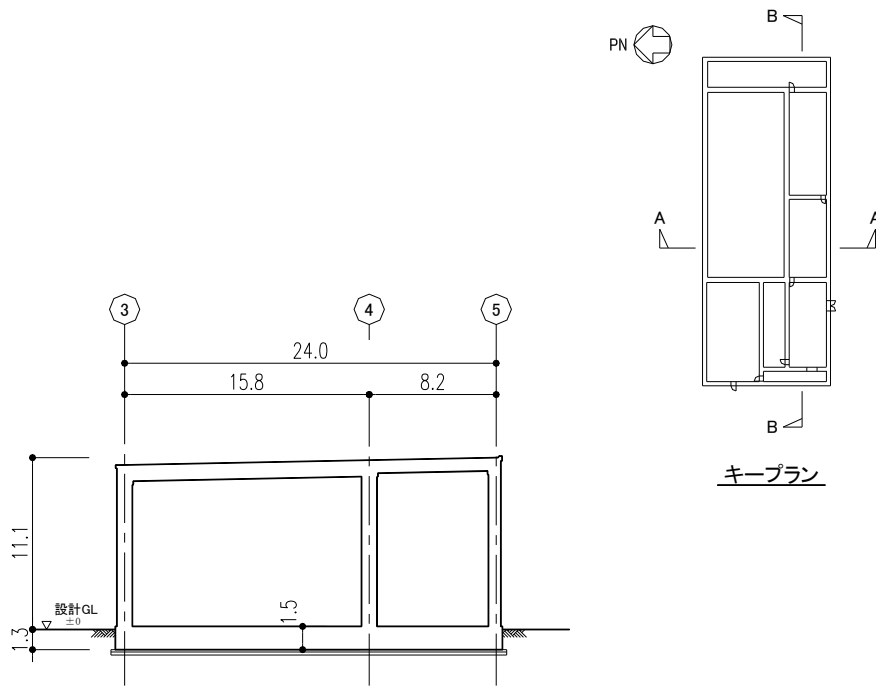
スラッジ棟 A-A断面図 (NS 方向) (単位 : m)
